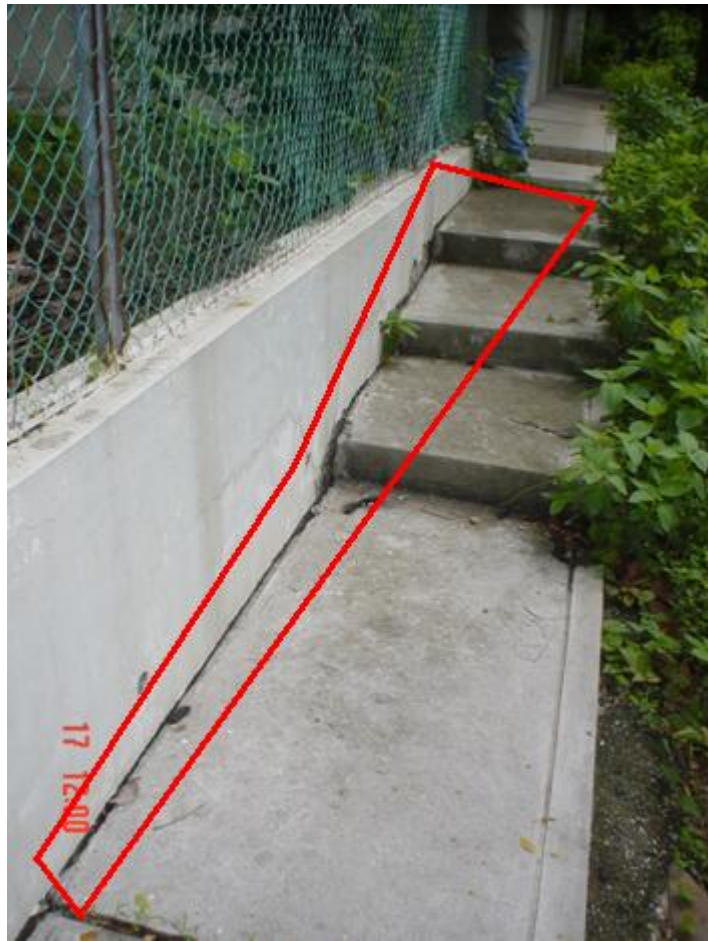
FISURAS Y DETERIORO EN CAMINERAS Y ESCALINATAS
